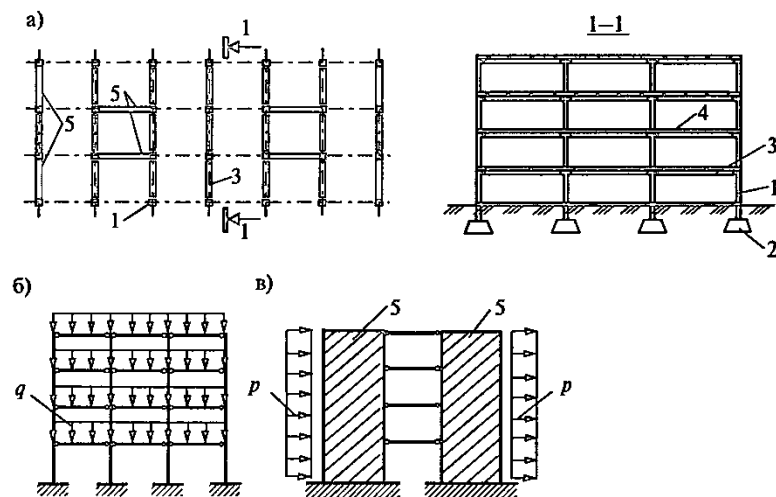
Связевой каркас здания: а) план здания, разрез; б) расчетная схема при расчете на вертикальную нагрузку; в) расчетная схема при расчете на горизонтальную нагрузку; 1 — колонна; 2 — фундамент; 3 — разрезной (однопролетный) ригель; 4 — плиты перекрытия; 5 — диафрагмы жесткости
